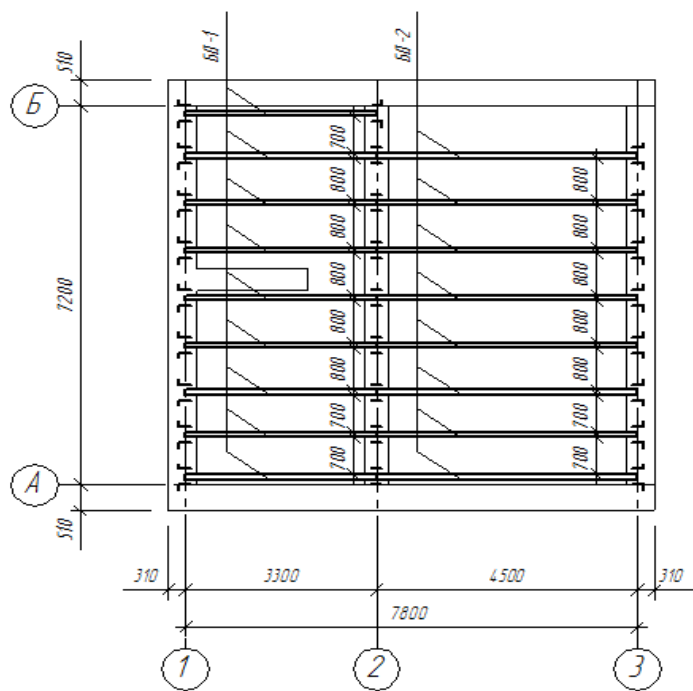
Пример выполнения плана перекрытий (балки)
